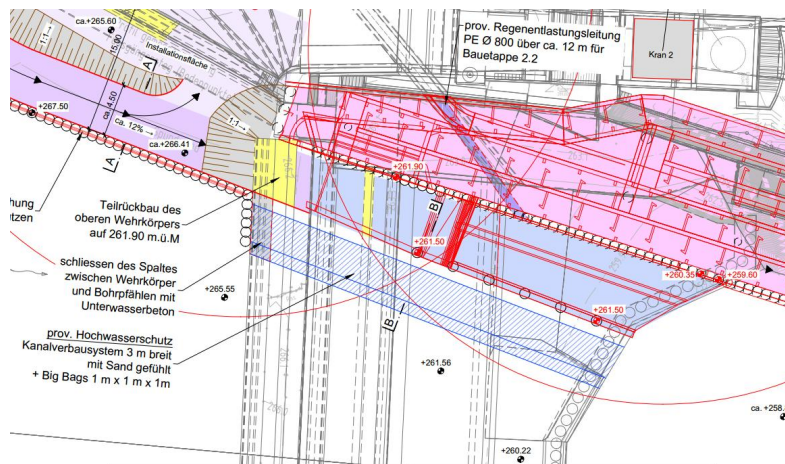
Situationsauszug aus dem Plan „Situation Bauetappe 2“, Plan-Nr. 1010-021-019
